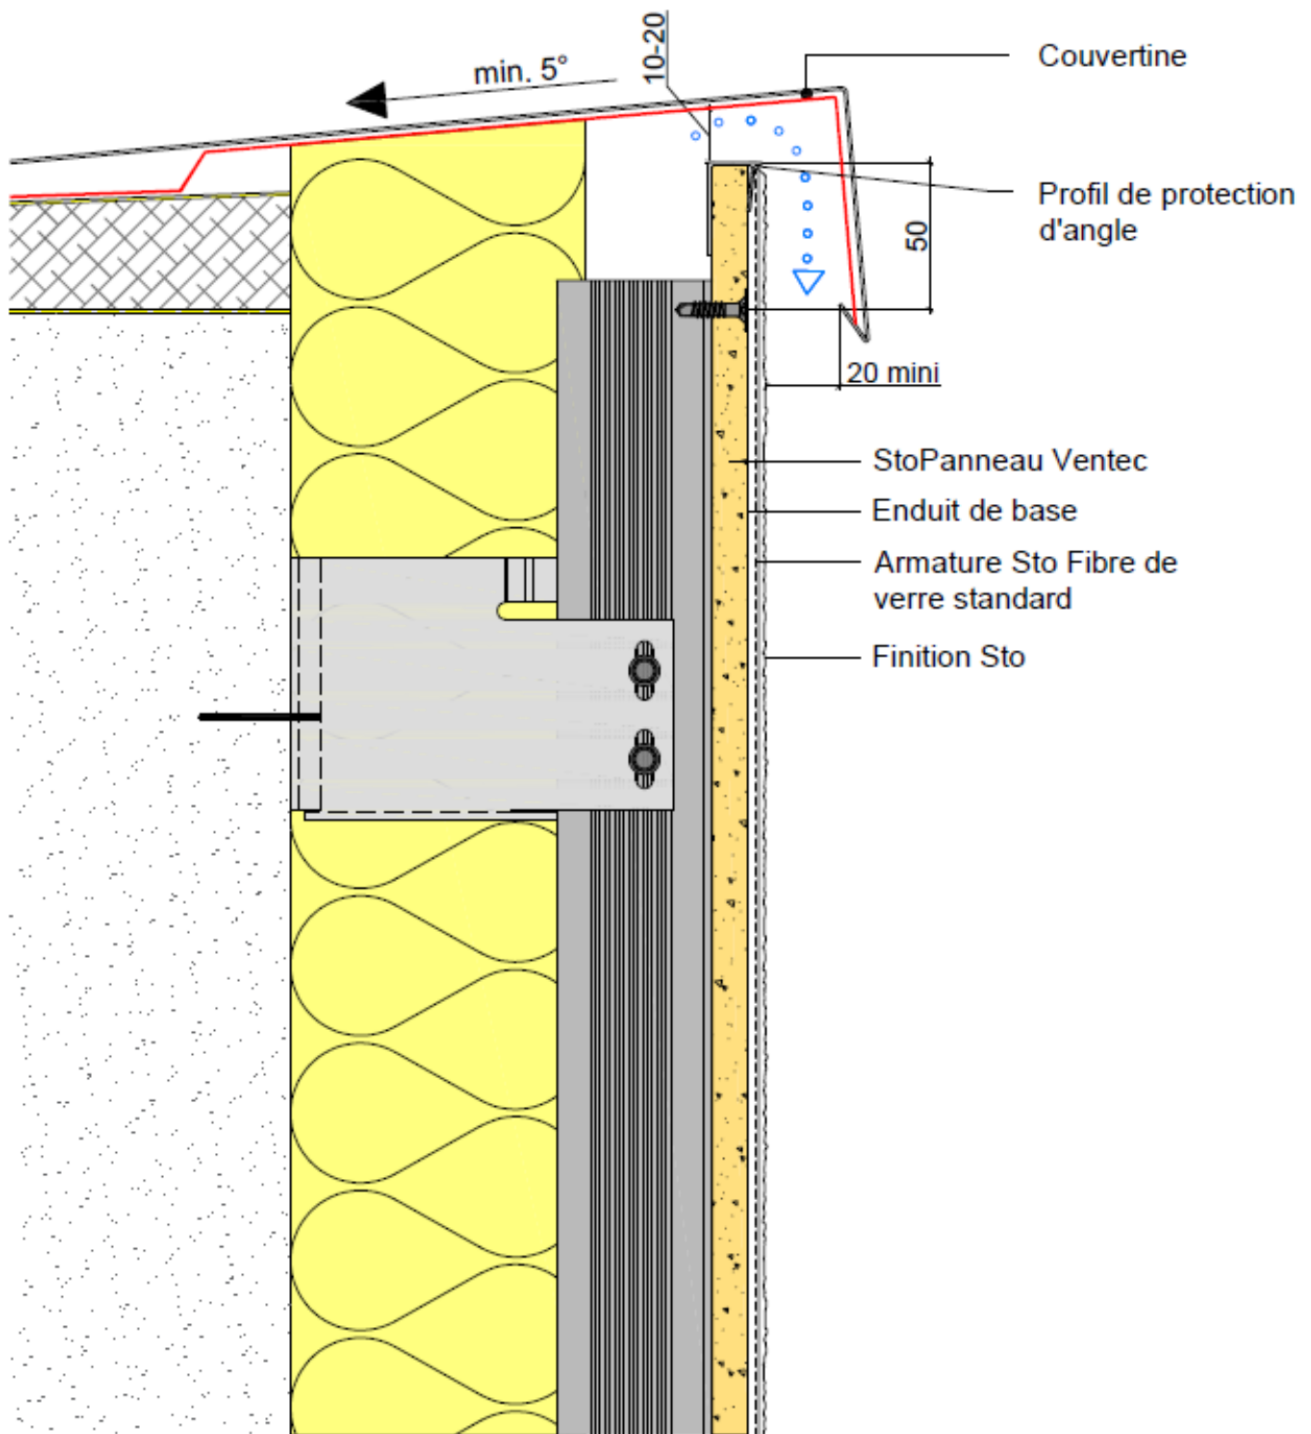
Coupe verticale – Acrotère - Ossatures aluminium sur support béton
